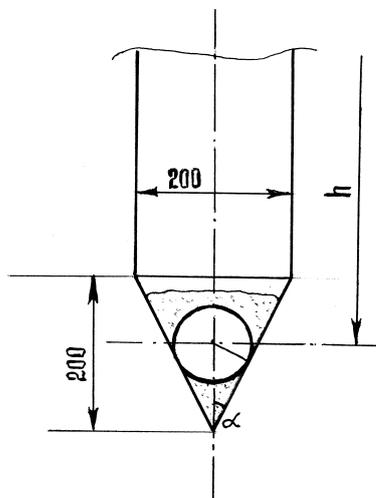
Схема укладки дренажных труб в конусное углубление
